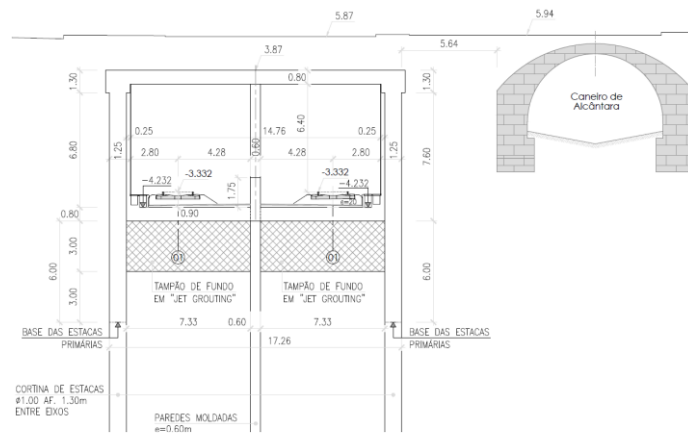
Secção tipo do túnel ferroviário na zona de Alcântara
